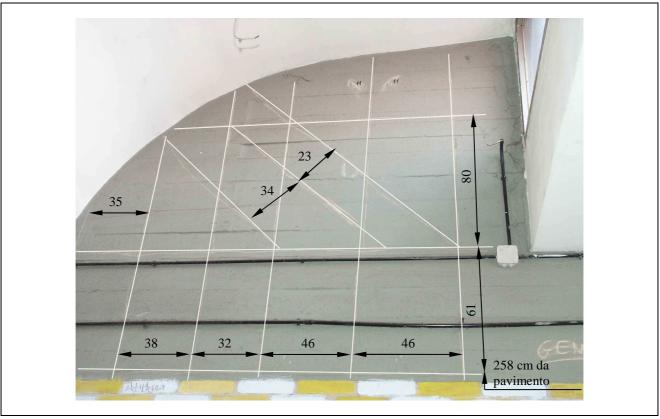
Trave TS, piano secondo (in bianco sono evidenziate le armature).
